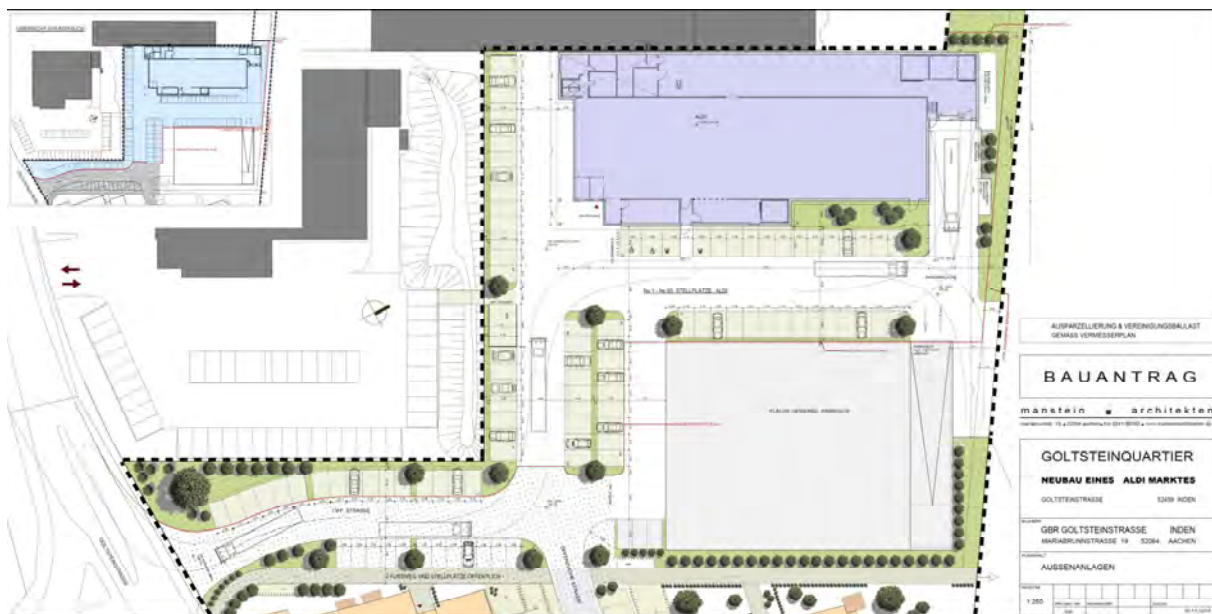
Lageplan Außenanlagen © Manstein Architekten
